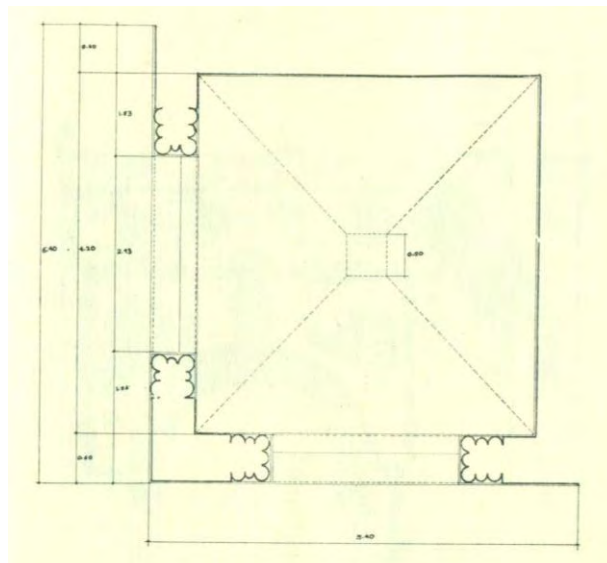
Planta arquitectónica de las capillas posas en Huejotzingo (Salas, 1982, p. 97)
